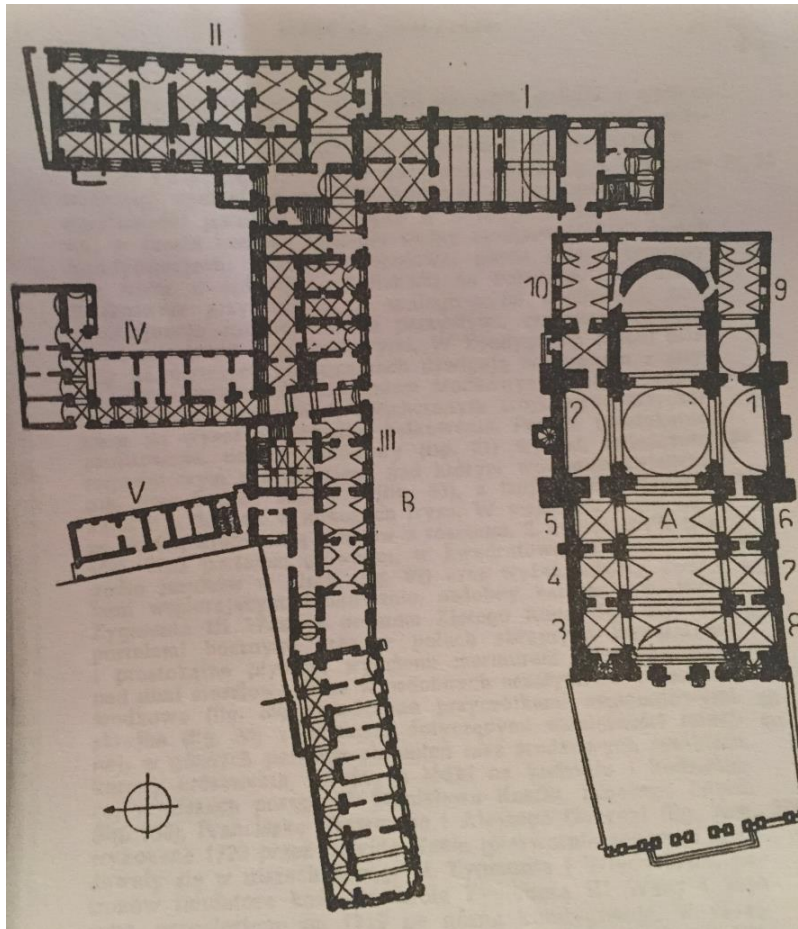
Grundriss der SS. Peter und Paul Kirche und des ehemaligen Jesuitenkollegiums, Krakau.
